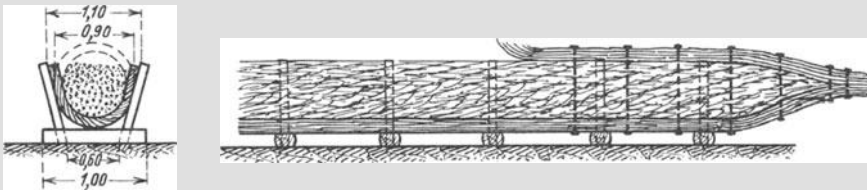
a u. b. Senkfaschine im Bau mit Querschnitt und Faschinenbank.
